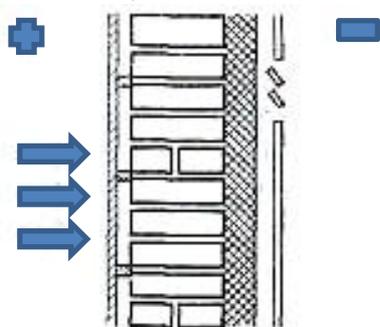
Кирпичная стена с наружной теплоизоляцией и дождевым экраном.
